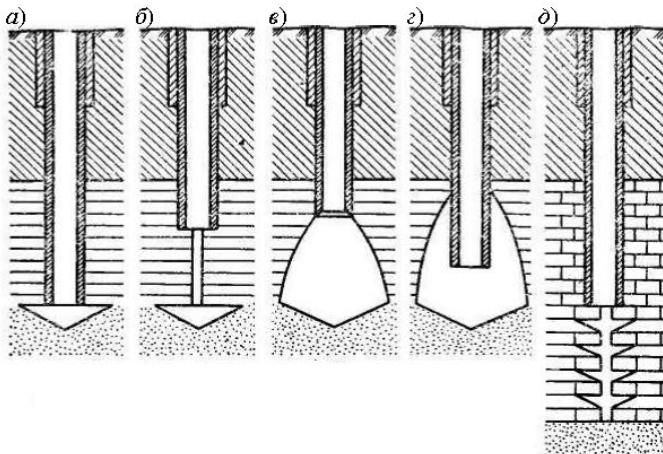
Конструкции бесфильтровых скважин:
